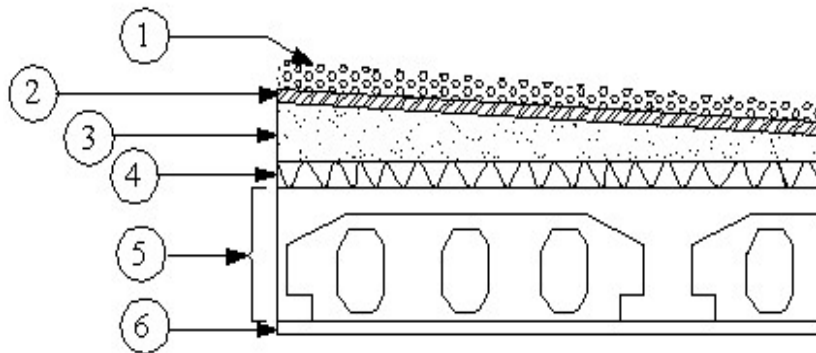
Coupe du plancher terrasse inaccessible (corps creux).
